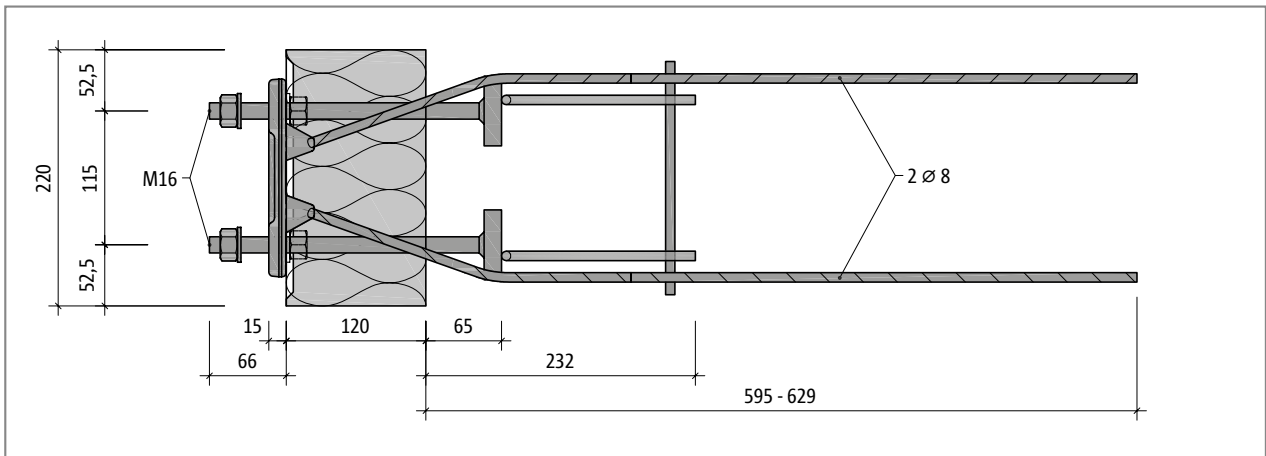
Schöck Isokorb® Typ QSXT8: Grundriss
